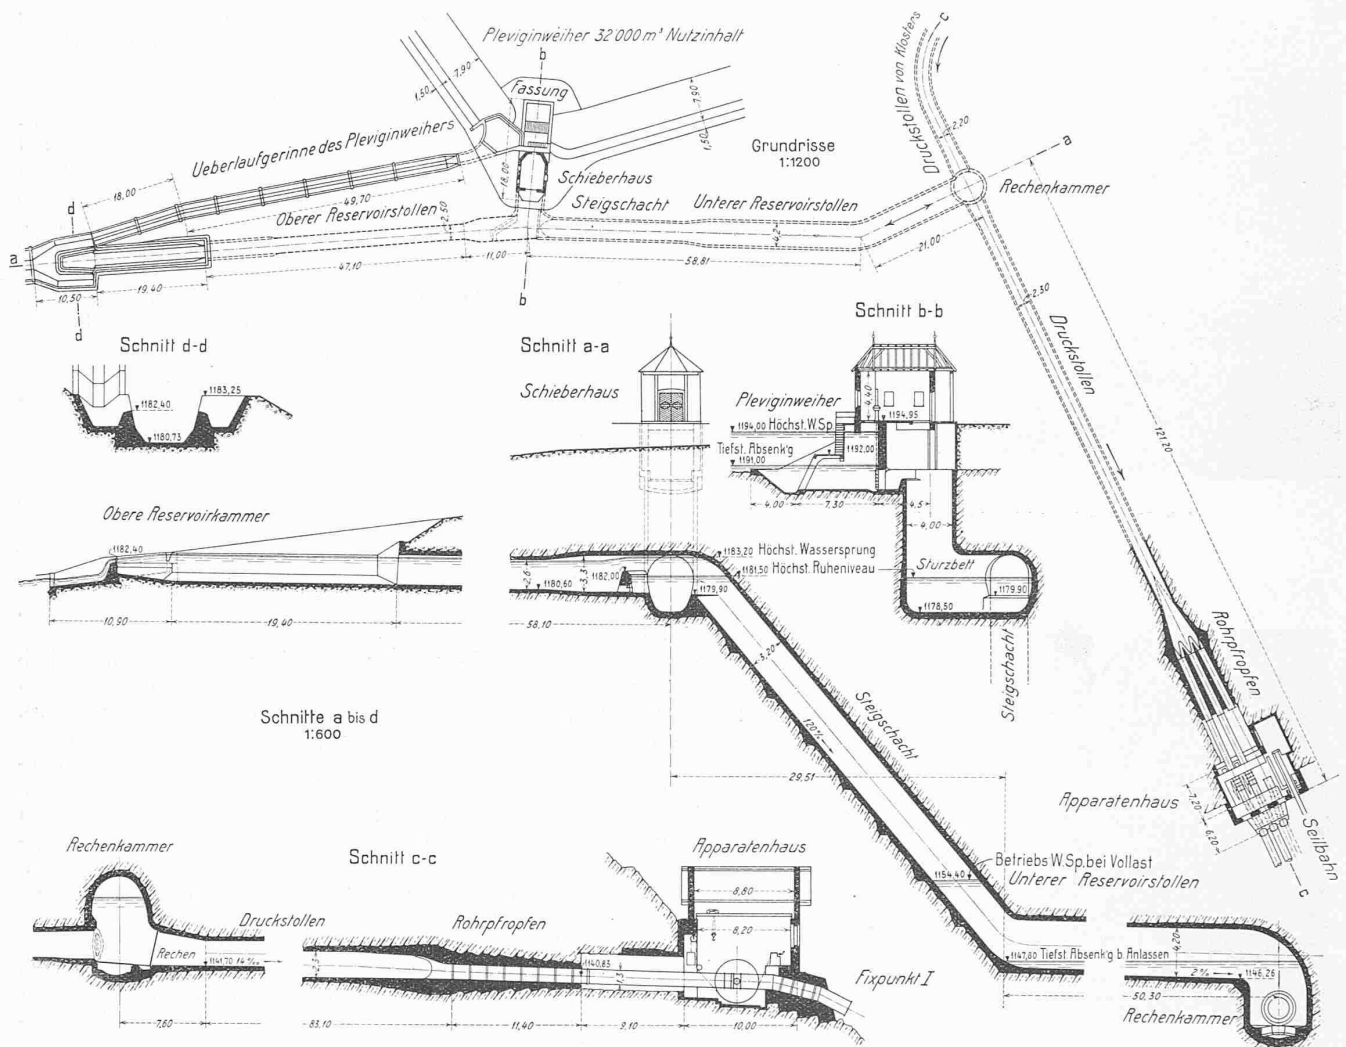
Das Wasserschloss samt Anschluss des Ausgleichweihers Plevigin, links oben der Ueberlauf. — Grundriss 1 : 1200, Schnitte 1 : 600.
